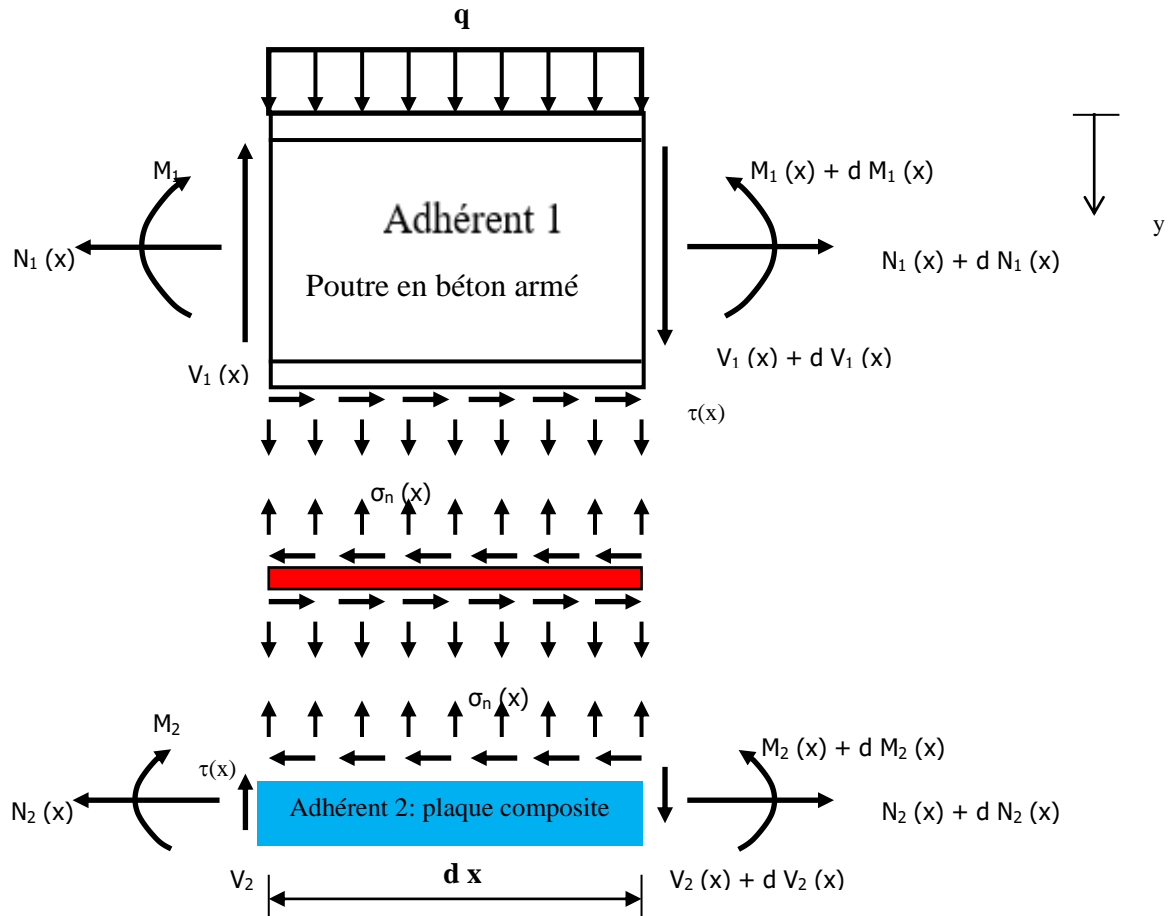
Un segment différentiel de la poutre en béton renforcée par collage de composite
